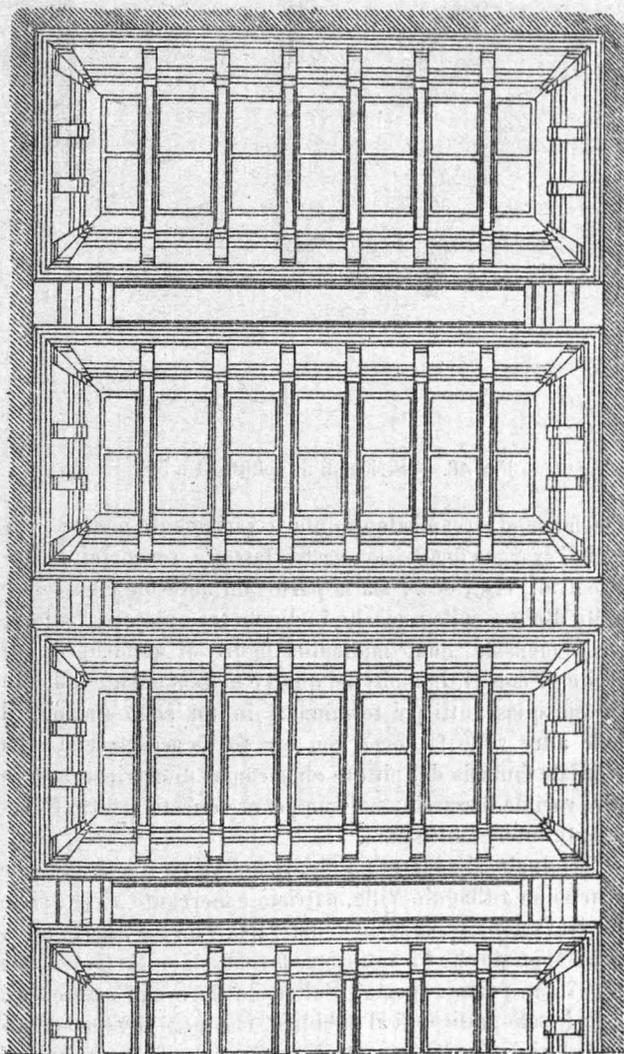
Metà pianta di un soffitto (1 a 50).
